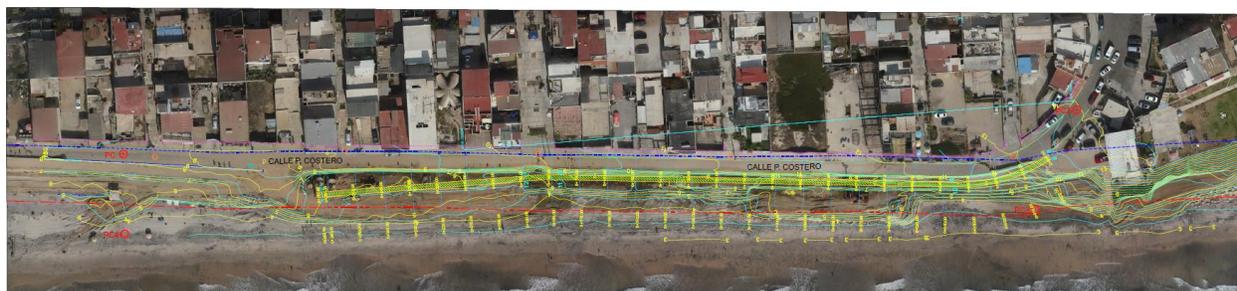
Plano de planta del deflector de oleaje y la topografía del sitio y predio colindante.
